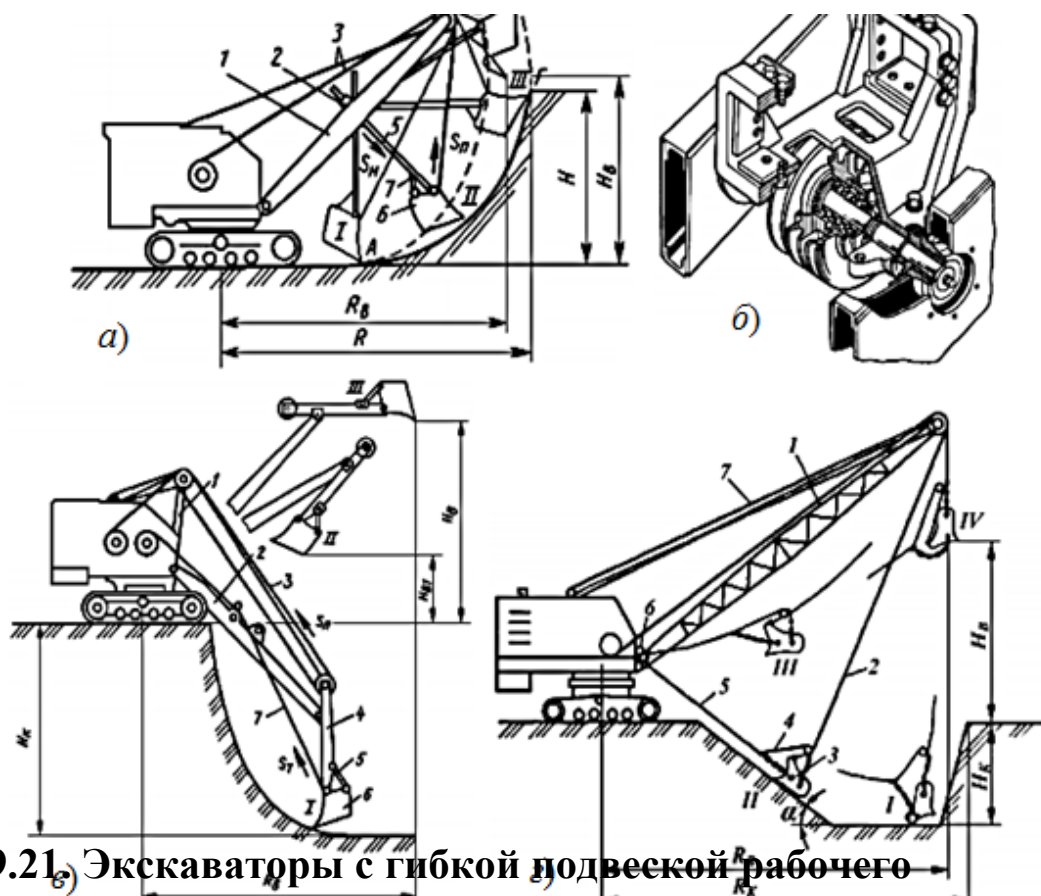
,г) Экскаваторы с гибкой подвеской рабочего оборудования: а – прямая лопата; б – седловой подшипник прямой лопаты; в – обратная лопата; г – драглайн.
